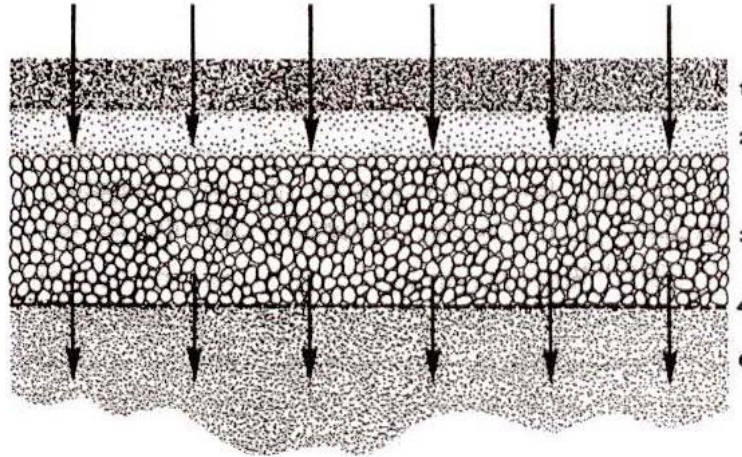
Disposición difusa local. El pavimento infiltra en el mismo terreno hacia la subrasante. El filtro geotextil es altamente permeable.
